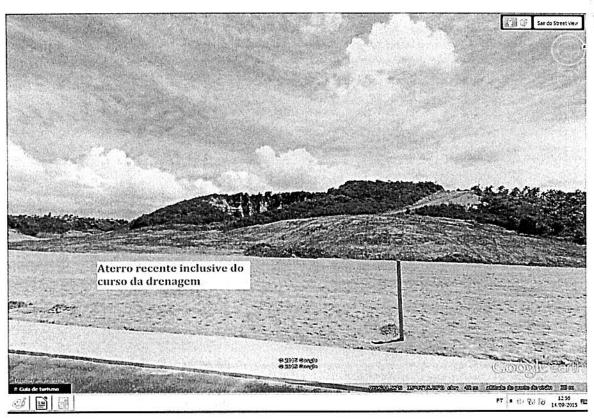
Condição do Terreno 6 após obras da Av. Pierre Chalita
